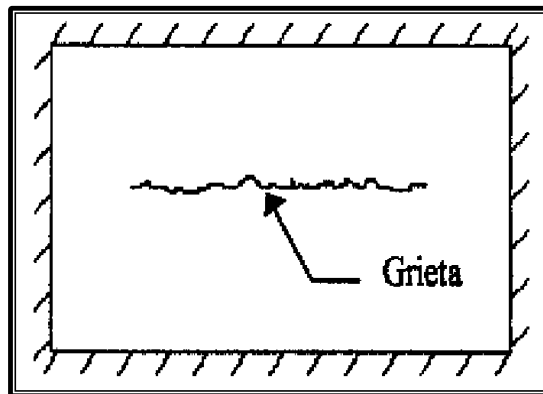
Grietas longitudinales al centro, en la cara inferior de la losa
